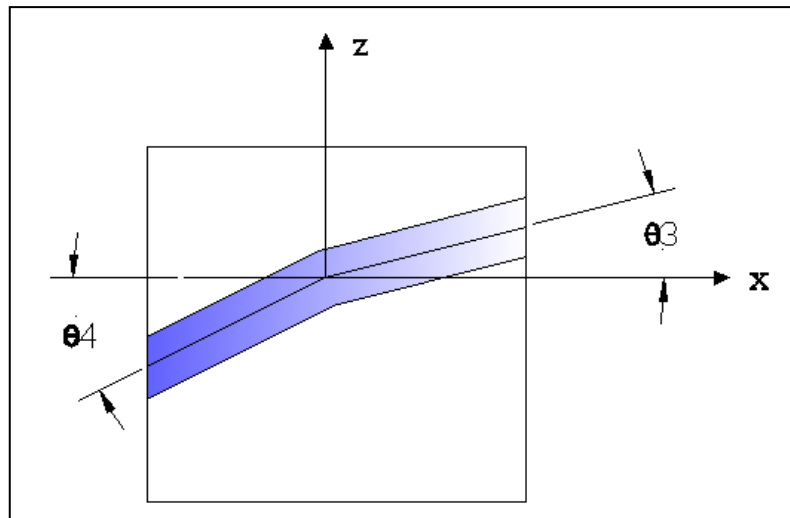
Ángulos de la tubería en el plano horizontal del anclaje. [3]
